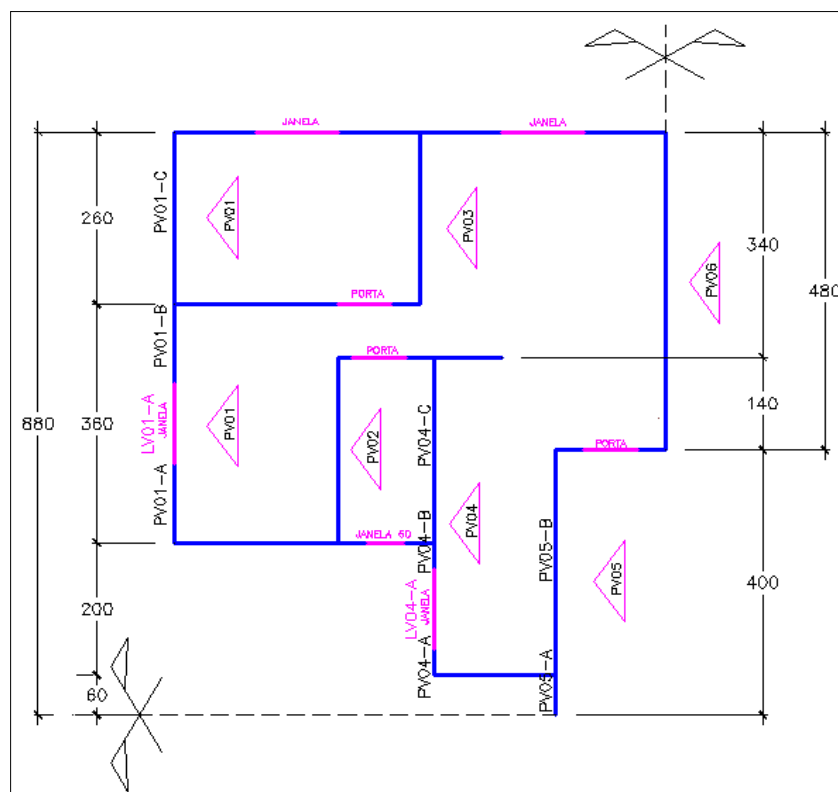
Planta baixa das paredes do edifício Colubandê 1 na direção vertical.
